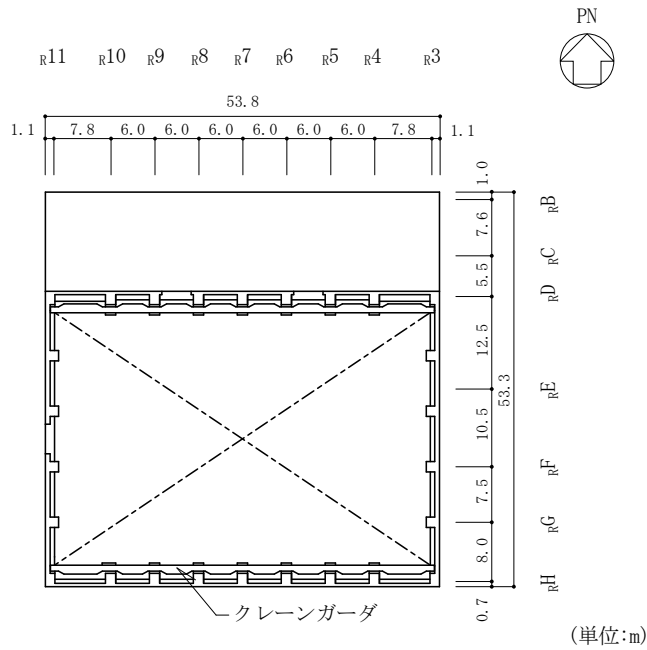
(8) 原子炉建物の概略平面図 (EL 51.7m)
